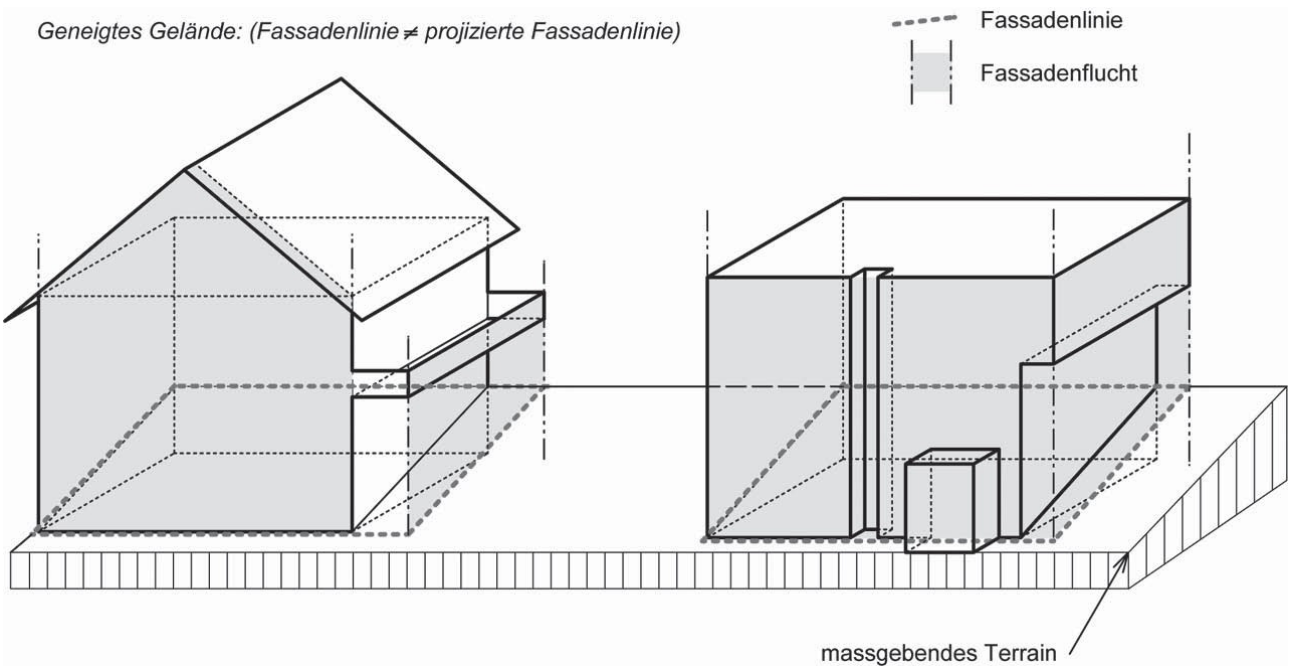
Fassadenflucht und (projizierte) Fassadenlinie
